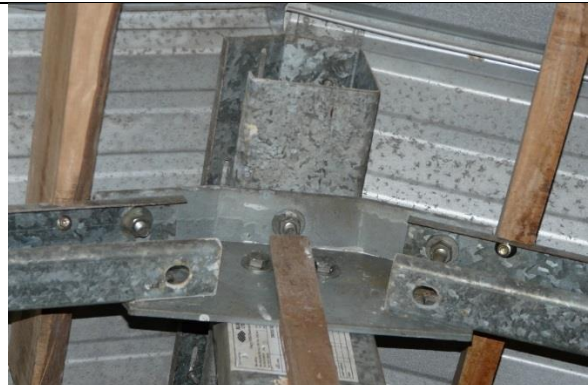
Assemblage entre colonne centrale et poutres toiture, vue de l'extérieur
